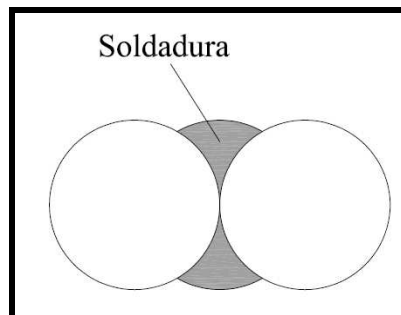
Soldadura de barras para anclaje.
